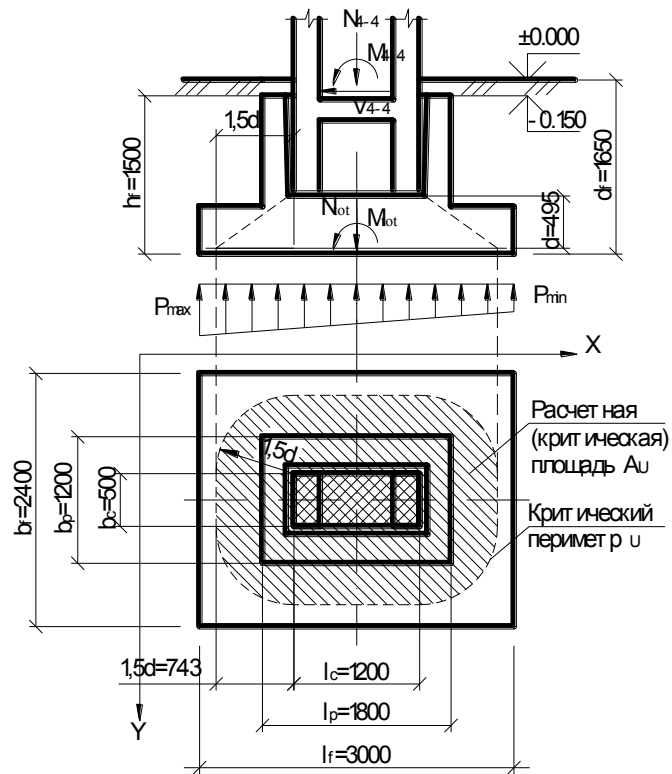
Схема фундамента с низкой стаканной частью к расчету на продавливание
